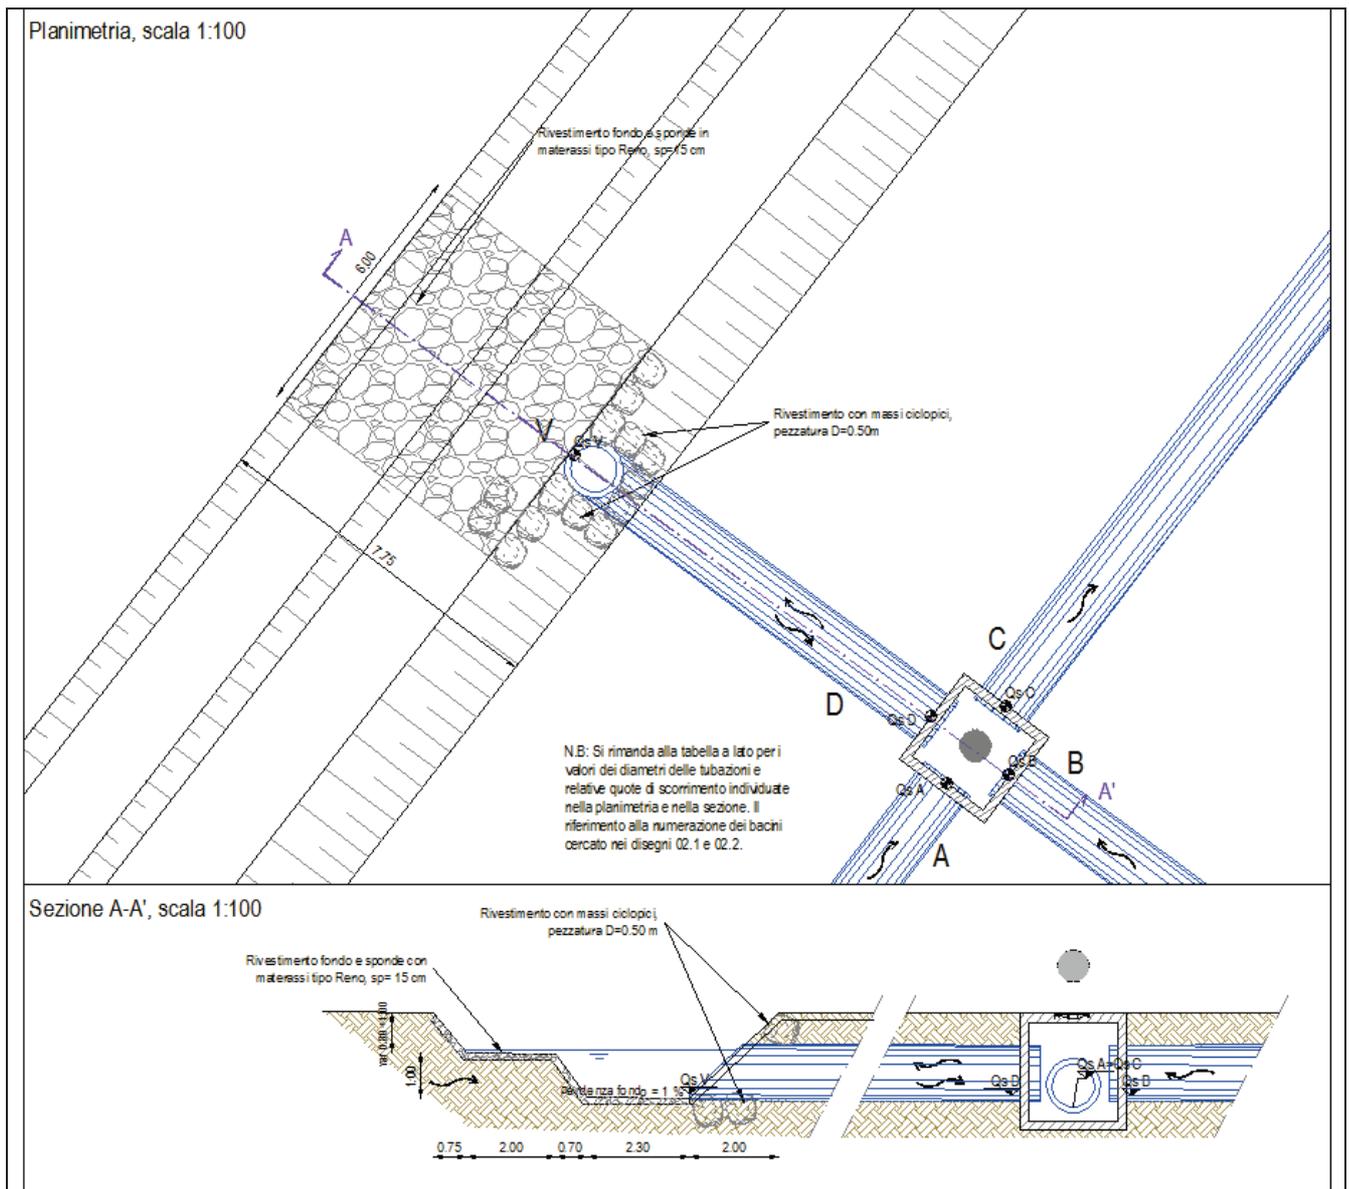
Particolari costruttivi ingressi ai bacini di laminazione.
